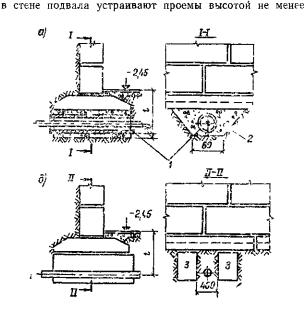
6. Пересечение вводоз и выпусков с фундаментами из сборного железобетона
